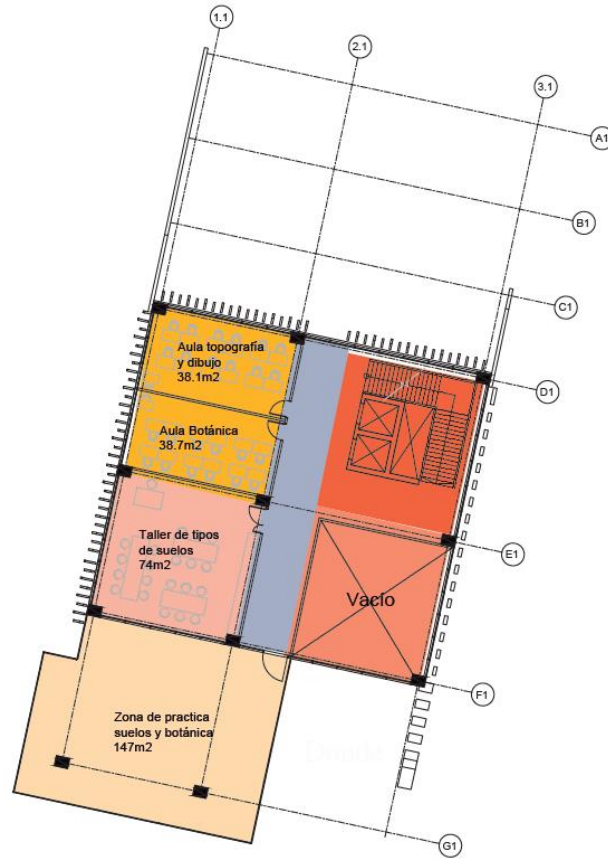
Zonificación Bloque B Cuarta Planta Talleres
